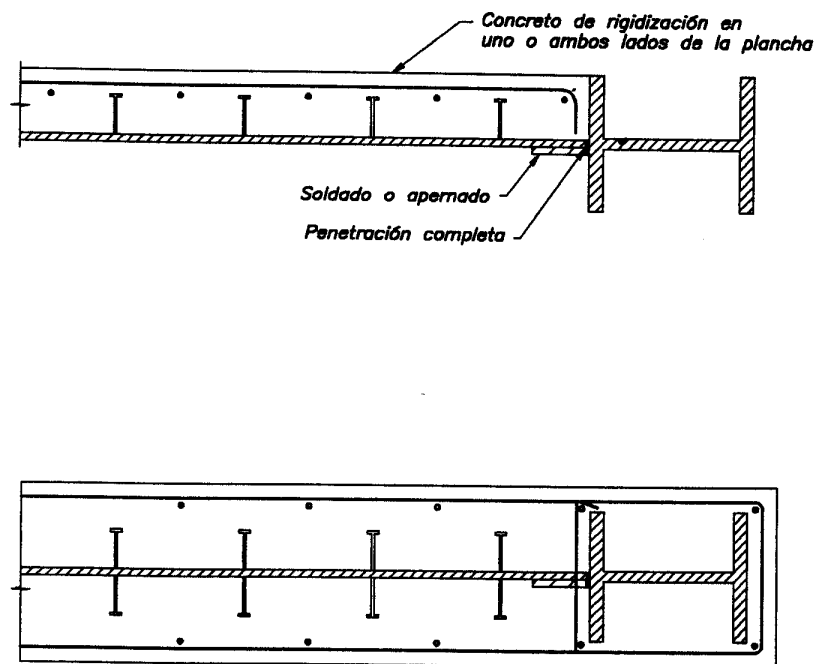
DETALLES TÍPICOS DE MUROS REFORZADOS CON PLANCHAS DE ACERO
